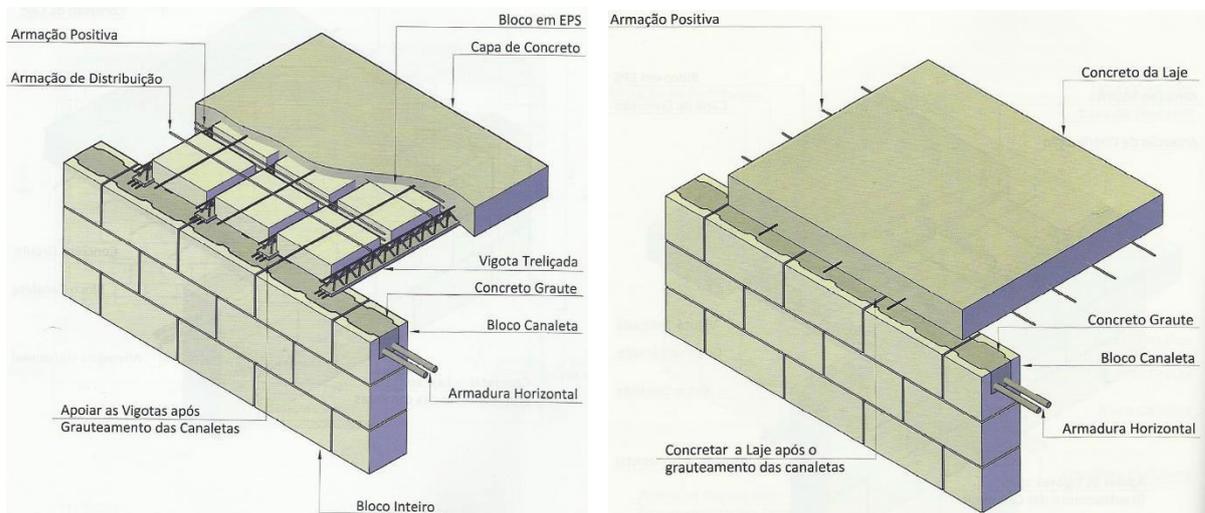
Processo de construção de laje treliçada mista e de laje maciça bidirecional, respectivamente. Fonte: NESE e TAUIL, 2010, montagem da autora.
